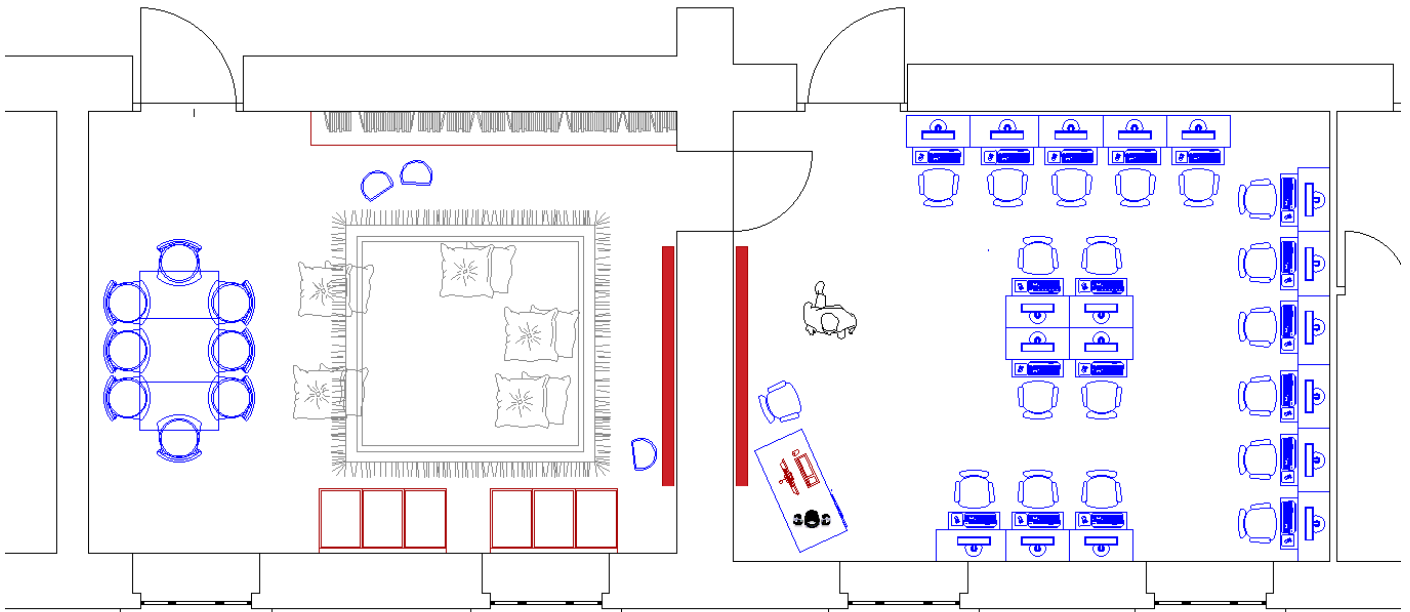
Pianta aula innovativa piano rialzato_plesso di via Ponte
